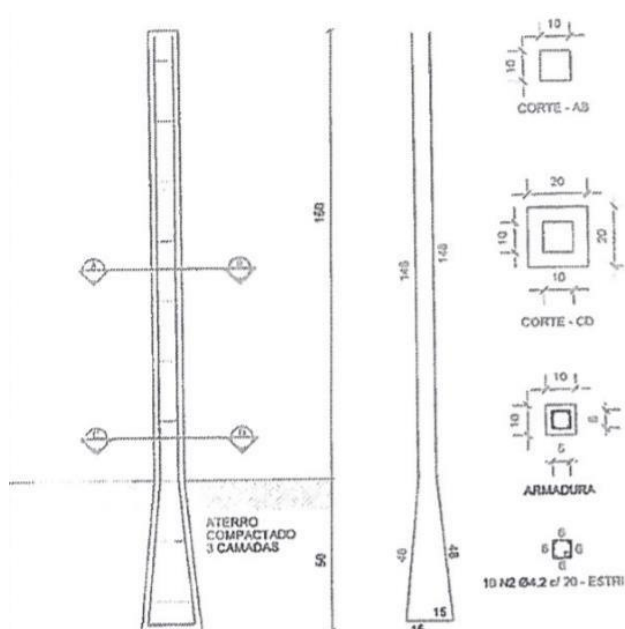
Exemplo de estaca testemunha de concreto a ser adotado em área rural.
